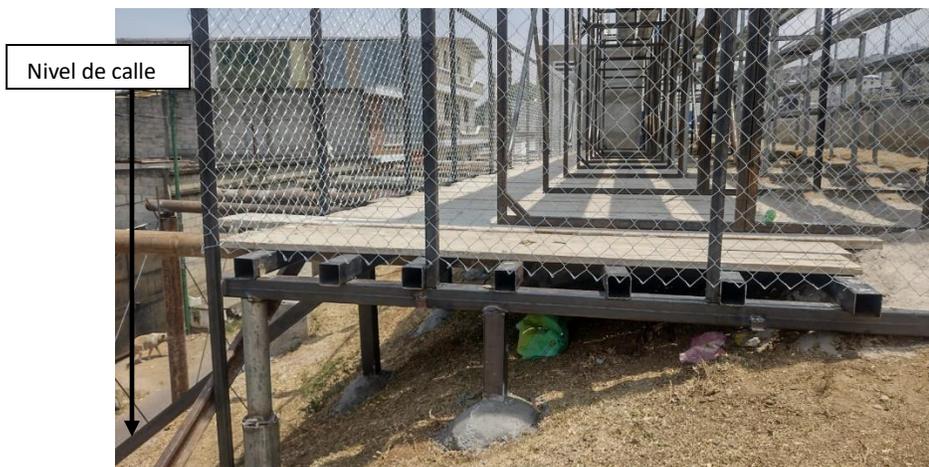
Conformación de plataforma para emplazamiento de graderío metálico.
